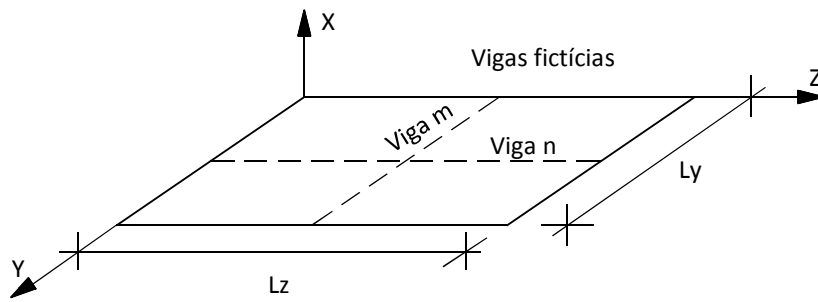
Laje retangular e duas vigas fictícias [182]
